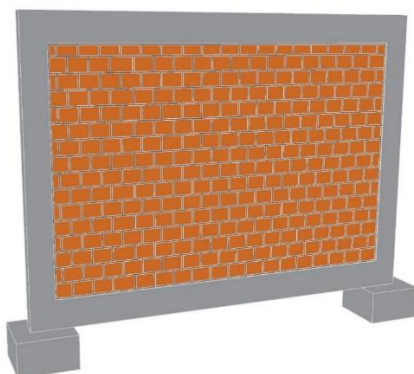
Modelo da parede maior em concreto armado e alvenaria.
